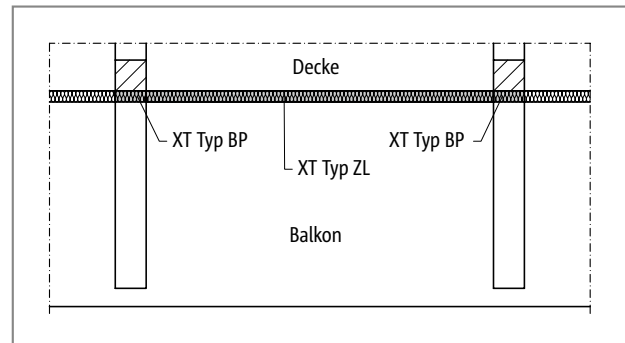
Schöck Isokorb® XT Typ BP: Balkonkonstruktion mit frei auskragenden Unterzügen
